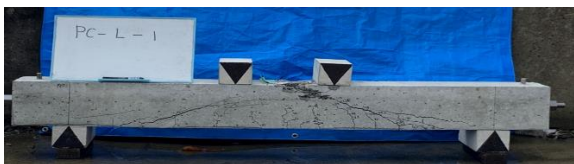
ひび割れ発生状況(PC-L-1)
